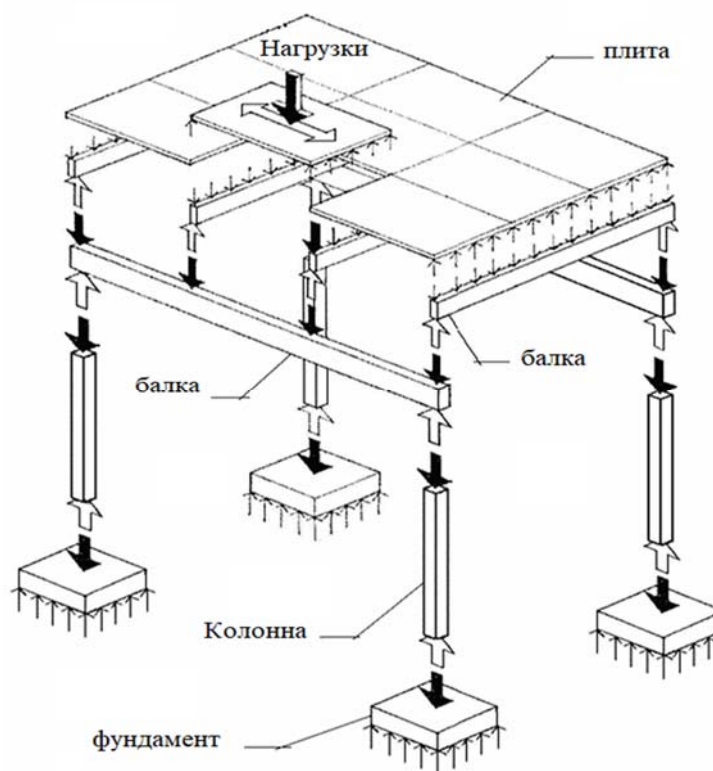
Передача нагрузок в балочно-колонной системе
